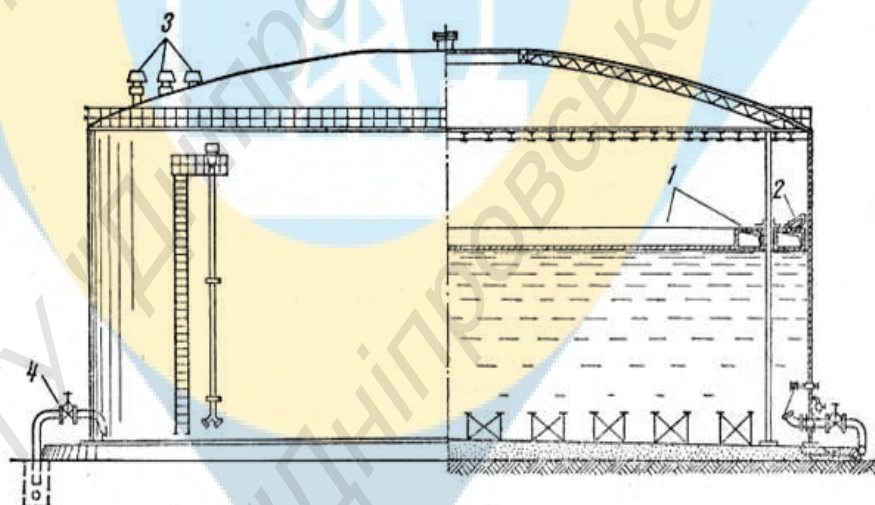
Резервуар вертикальний сталевий з понтоном:
